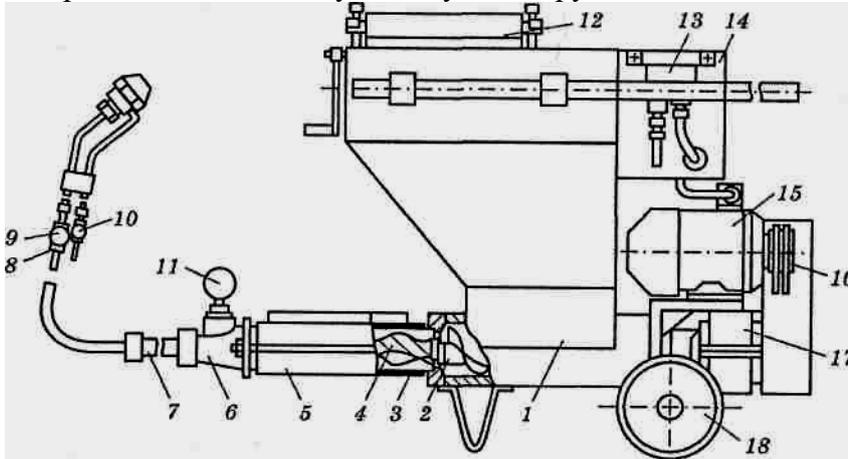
Шпаклювальний агрегат СО-150 (для нанесення полімерцементних паст):
